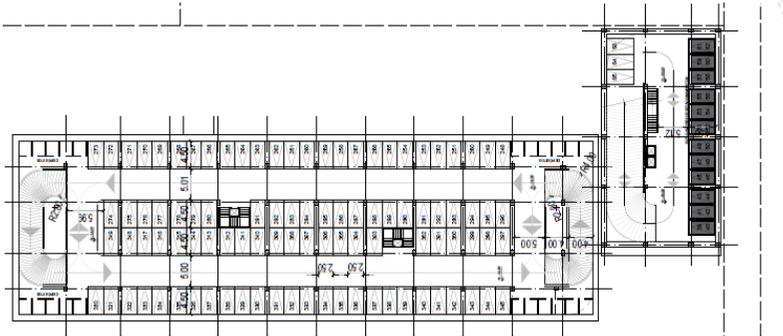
PF 13. Planta Estacionamientos – Sótano 4
